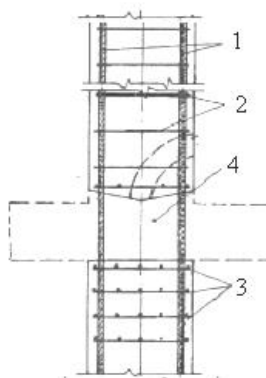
Конструкция сборных колонн с нишей для размещения несущих и связевых ригелей
